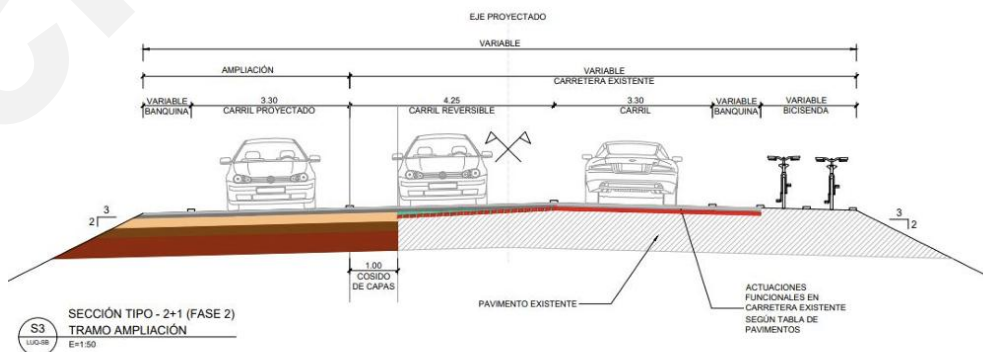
Sección tipo – Tramo 14 con Carril reversible
